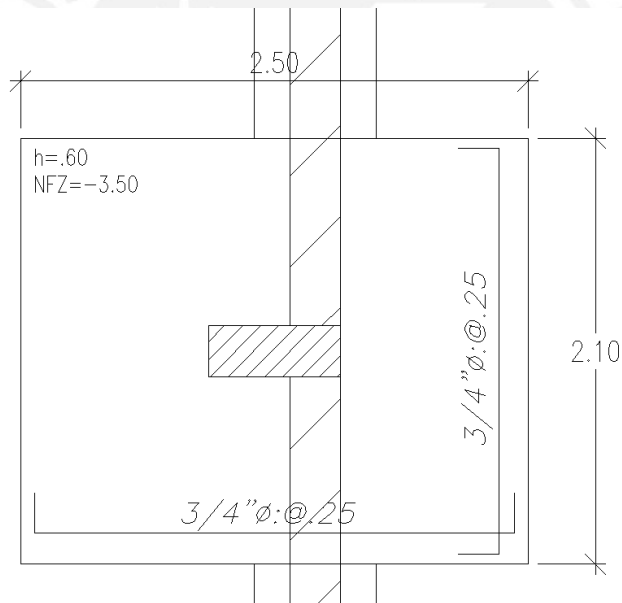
Armado de la zapata ubicada entre los ejes 5 y E
